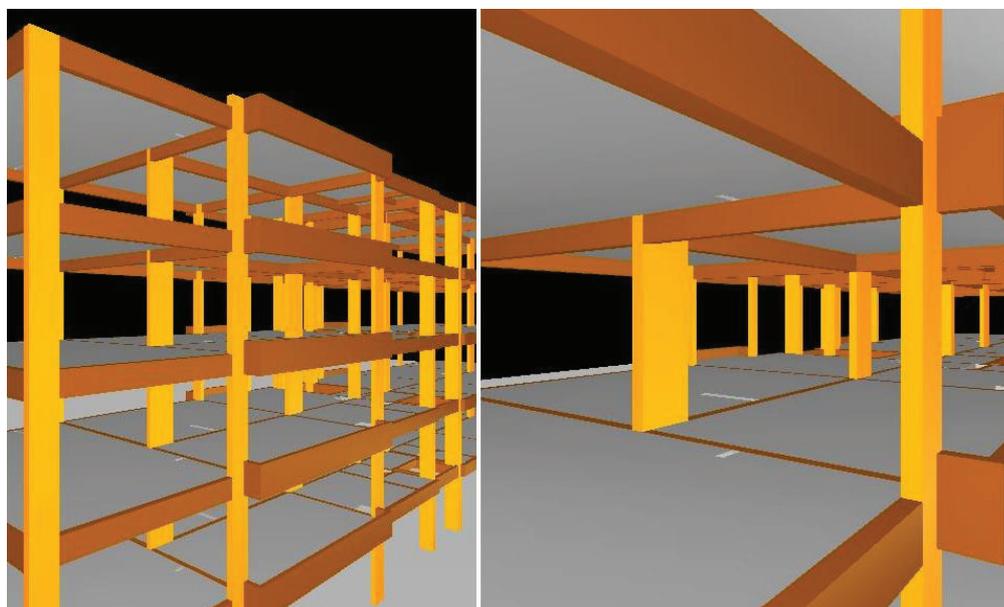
perspectiva dos pavimentos tipo da estrutura em laje convencional
